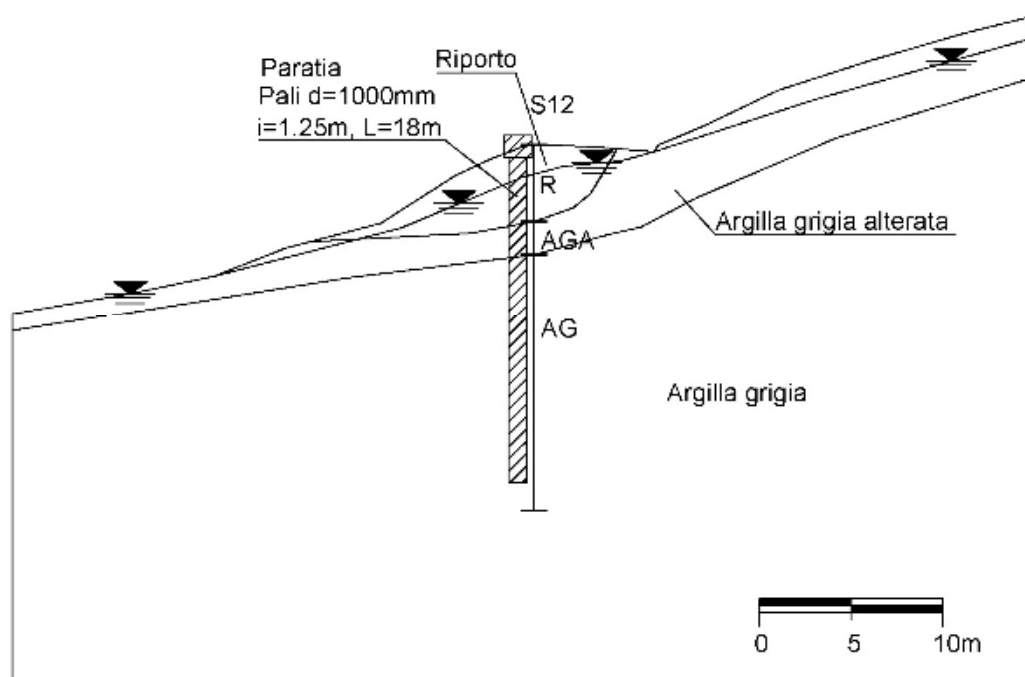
Dissesto al km 18+400. Sezione con schema degli interventi di consolidamento.
